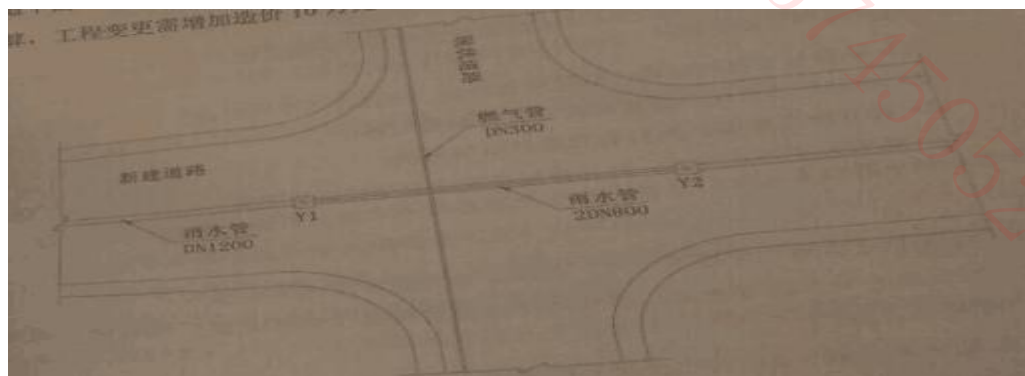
设计变更后的管道平面位置示意图（单位：mm）
